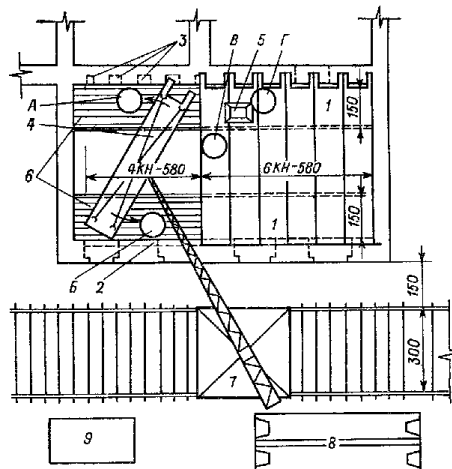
Схема организации работ по монтажу участка перекрытия из железобетонных пустотных настилов с выпускными консолями
